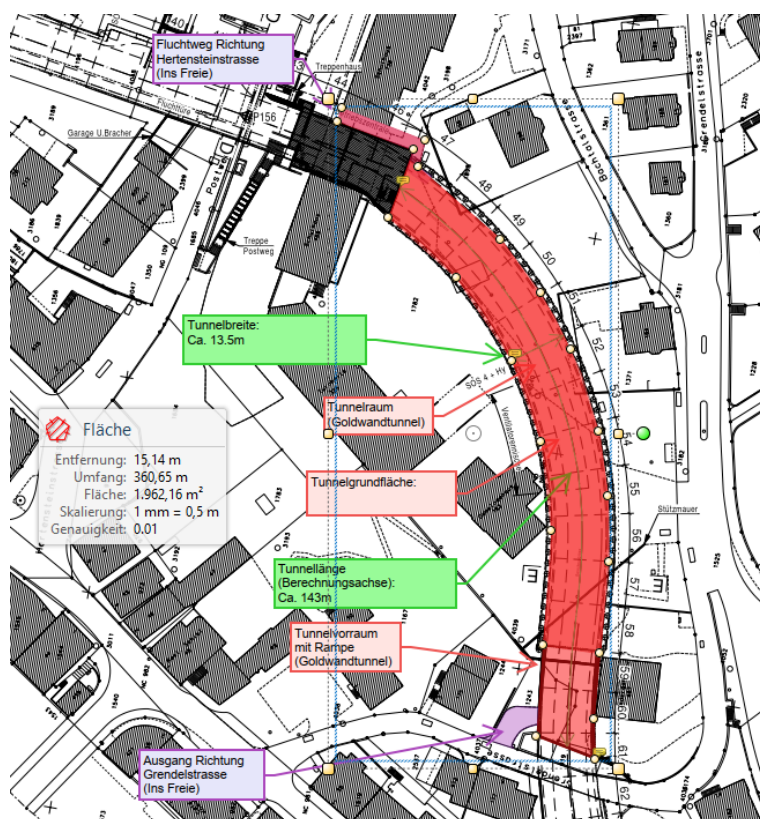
Vorhandene Grundfläche im Tunnellagererraum
